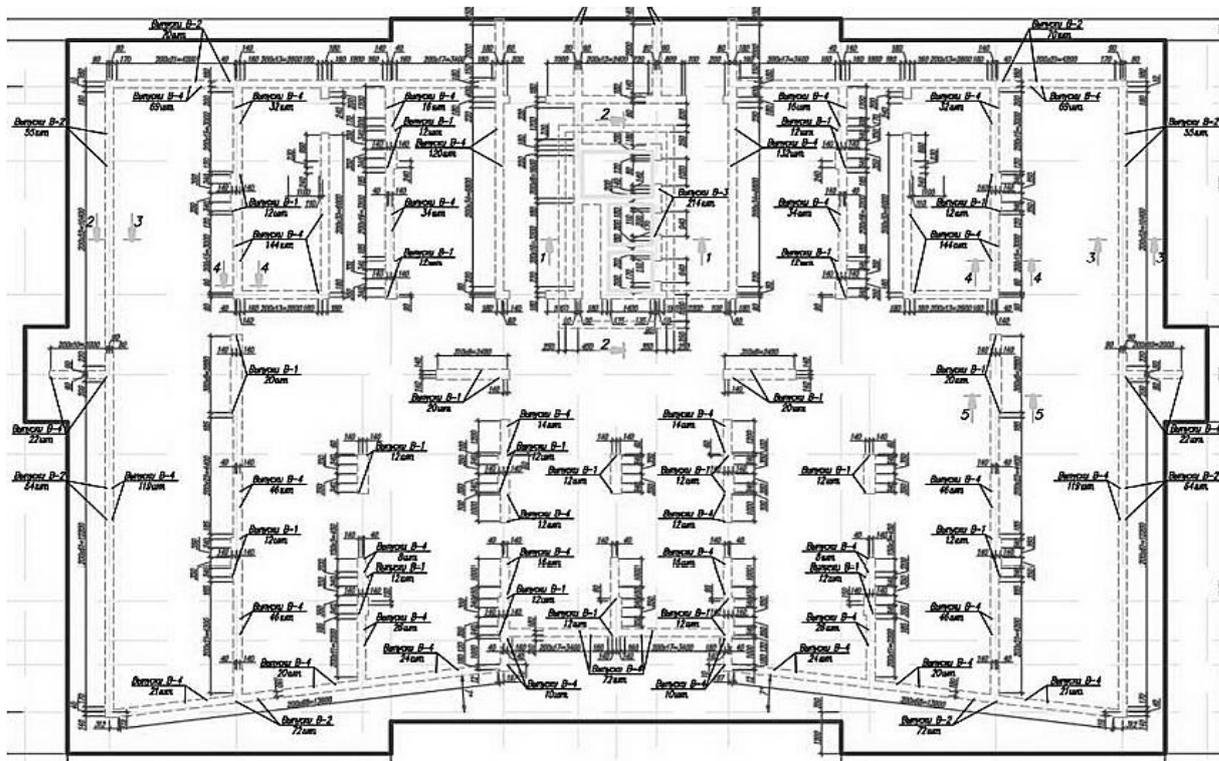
Опалубочный план плитного ростверка комбинированного свайно-плитного фундамента (КСПФ)
